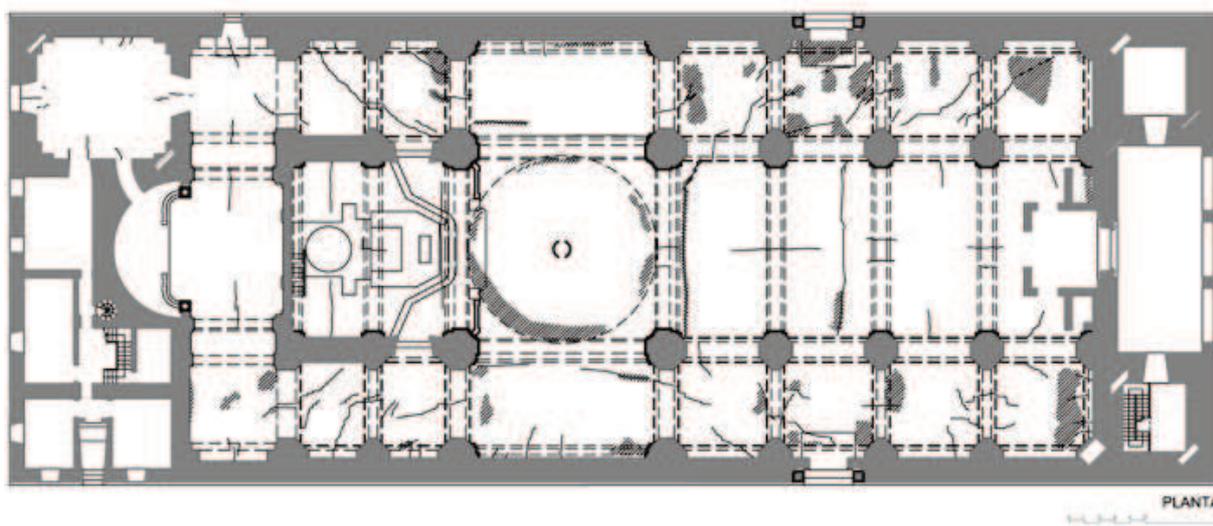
Plano de humedades y grietas del templo en 1995. Fuente: propia a partir de Proyecto de Joaquín López Davó.
